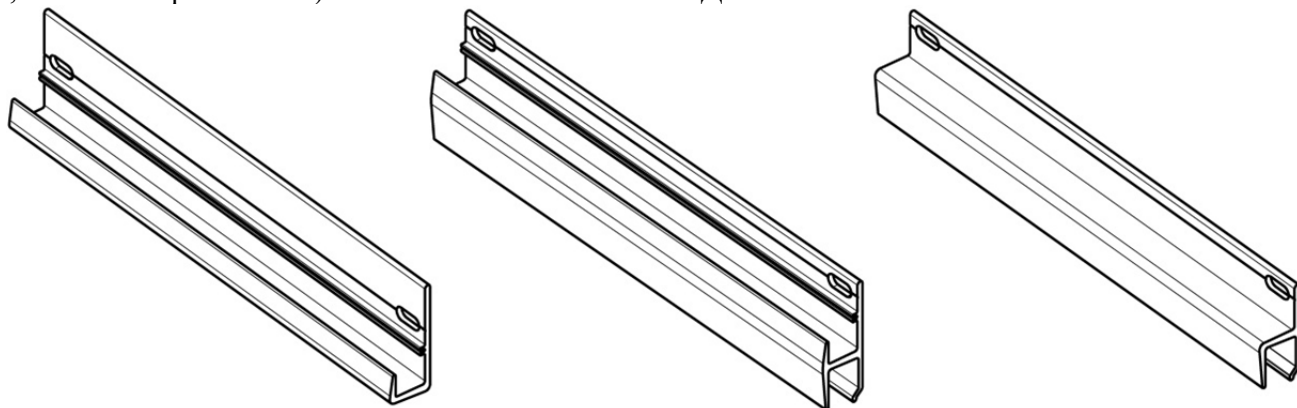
Кляммер-ригеля с пазами для закрепления плит фасадных на стойках.
